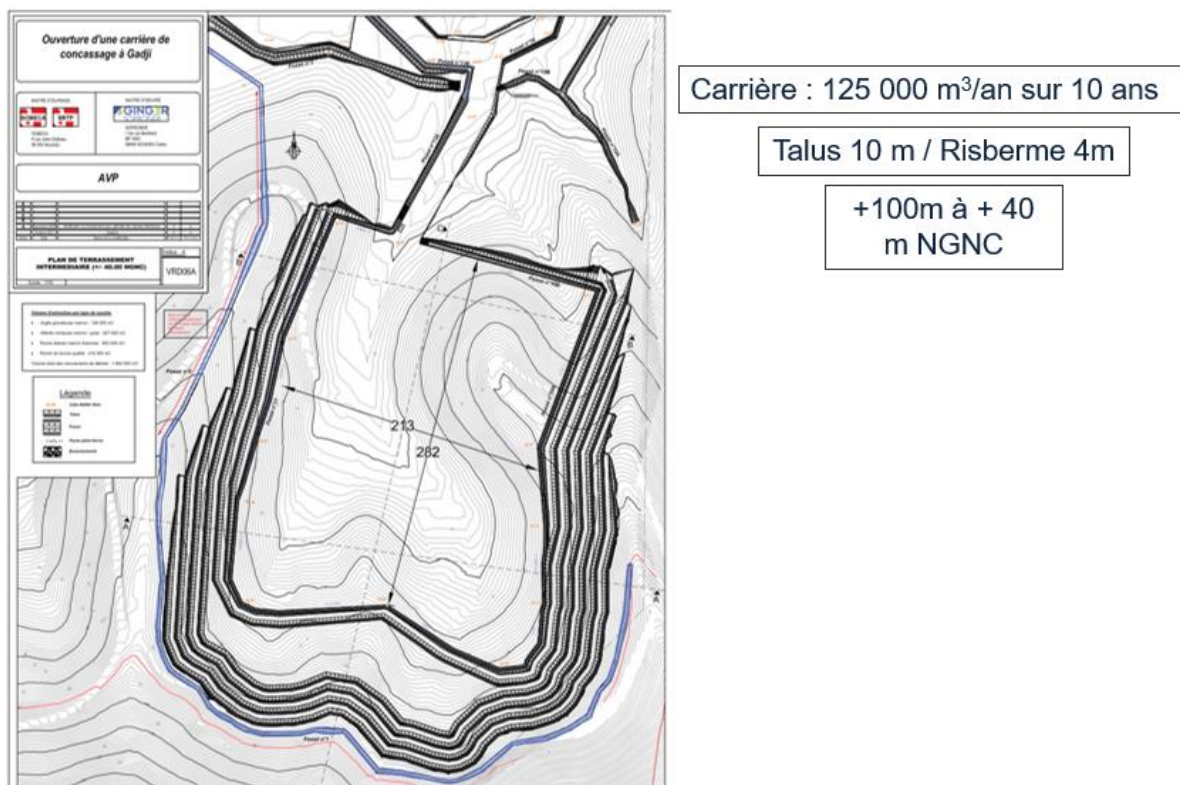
Plan de la zone d'extraction à T₀ + 10 ans
